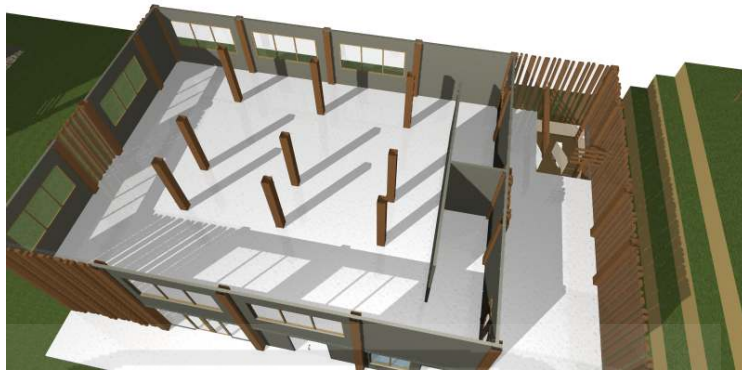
Layout kafetaria di ground floor bangunan fasilitas pendukung
